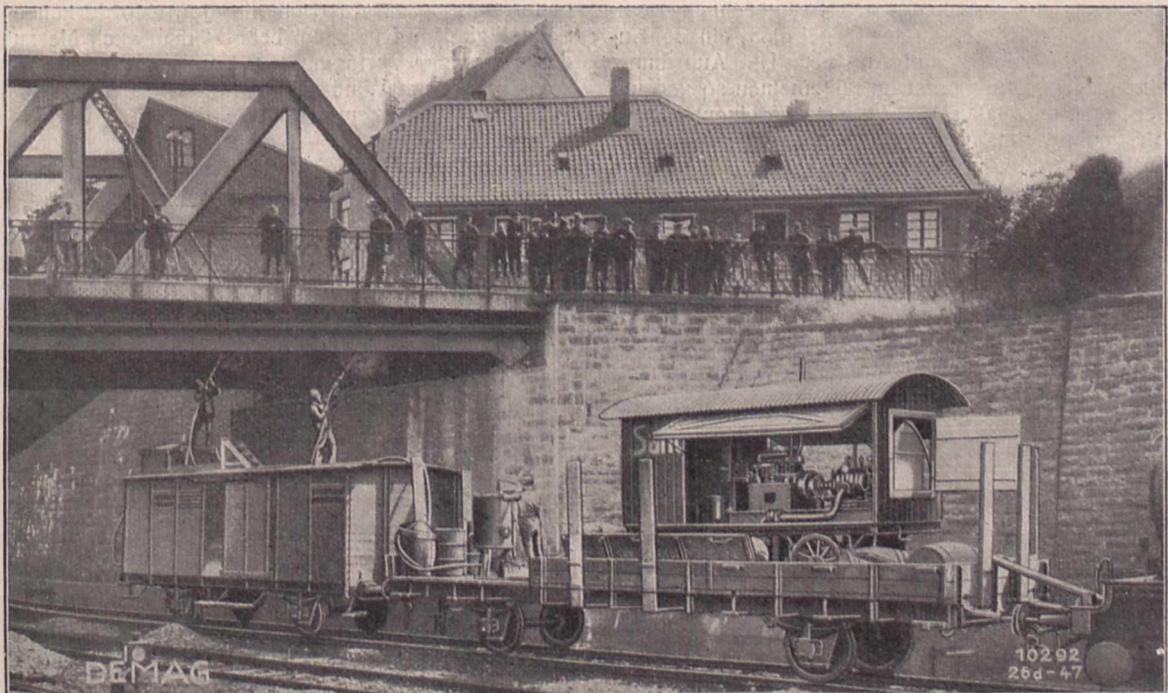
Demag-Rotationskompressor mit Sandstrahlgebläse beim Reinigen einer Brücke in Solingen.
